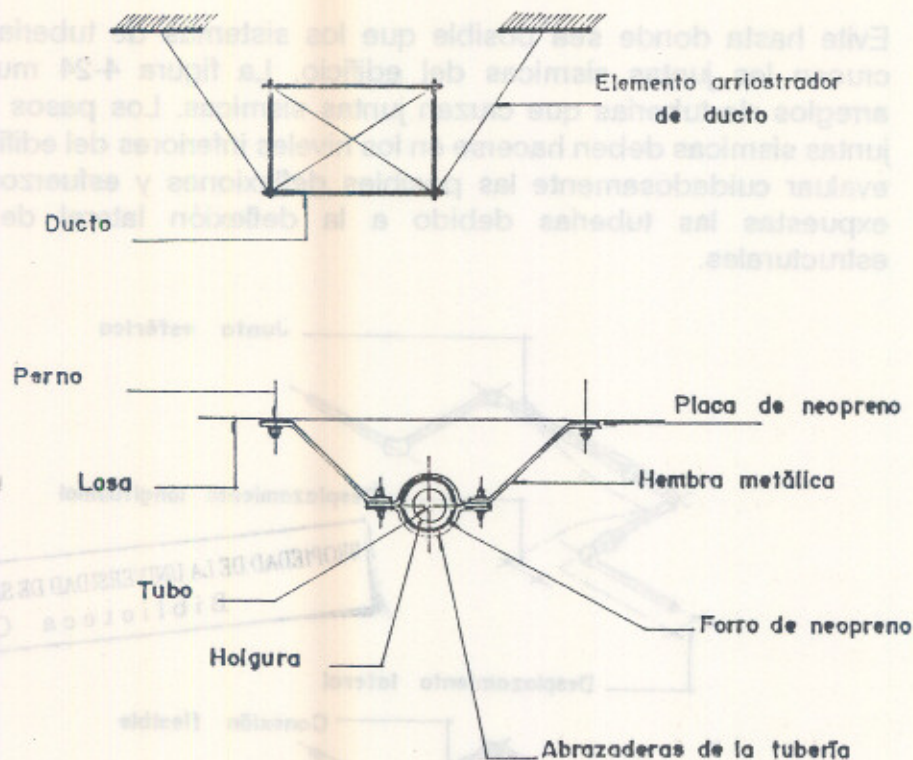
Arriostramiento y Aislamiento Vibracional para tuberías y conductos
